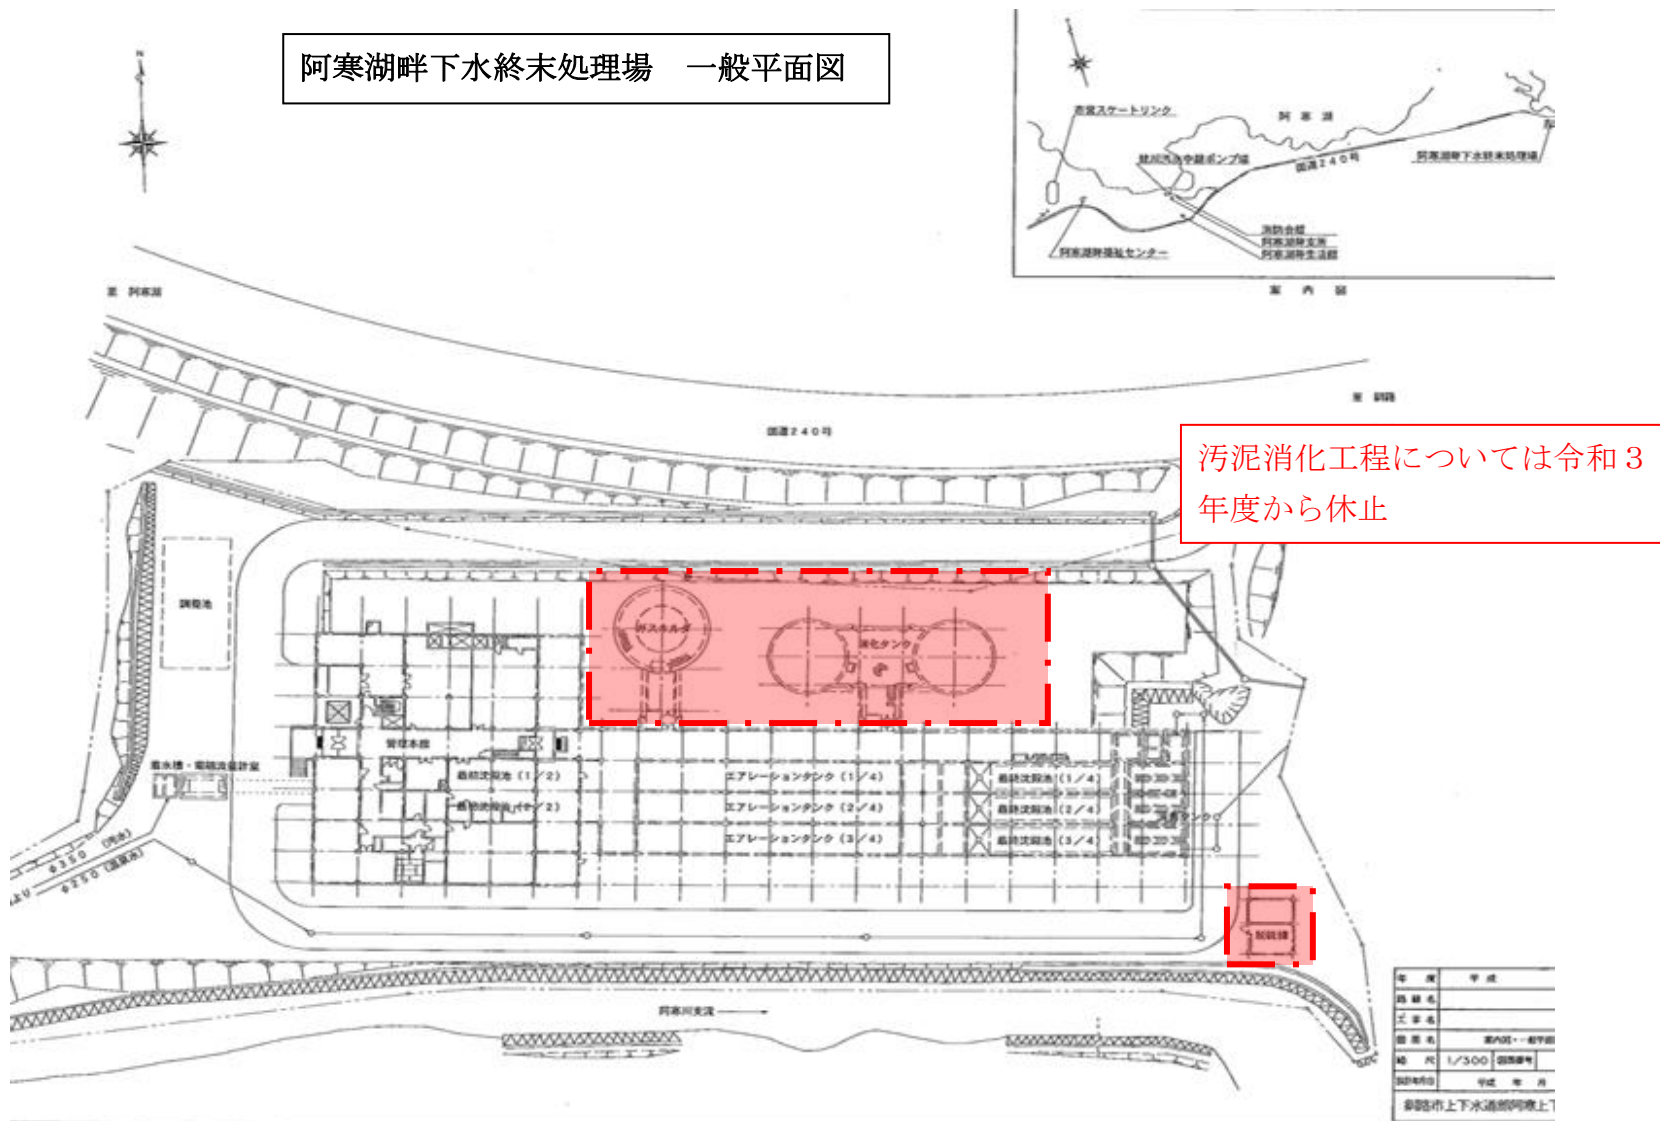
阿寒湖畔下水終末処理場一般平面図(現況)
